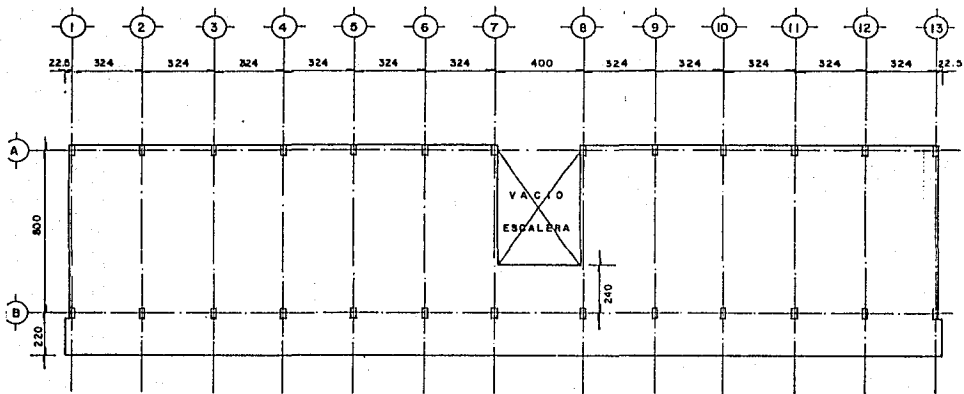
PLANTA NIVEL ENTREPISO.
